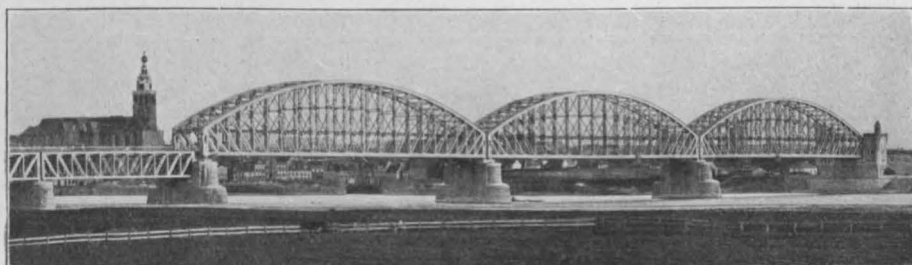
Eisenbahnbrücke über den Waal bei Nymwegen. VAN DEN BERGH. 1875—1880.
